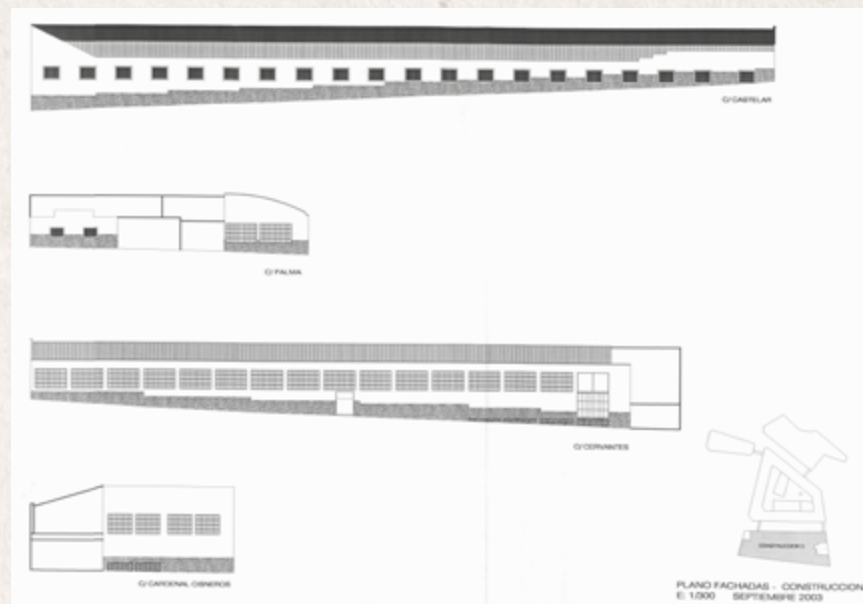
Alzado fachadas construcción 3 del complejo de Alfombras Imperial. Plano de Irene Moreno.
